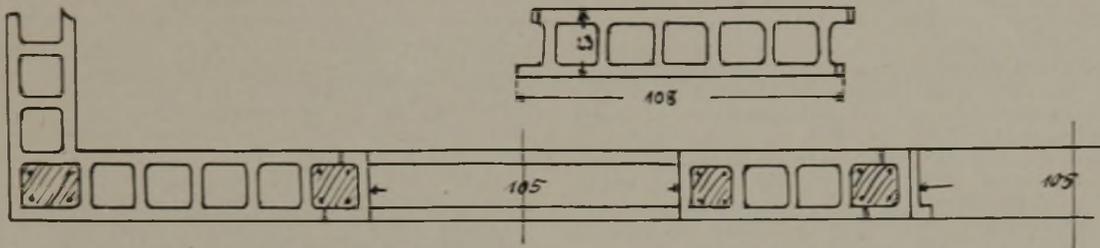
u. b. Grundriß und senkrechter Schnitt.
